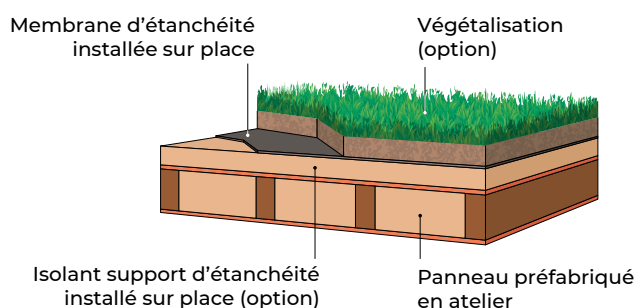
Panneaux préfabriqués de toiture-terrasse végétalisée
